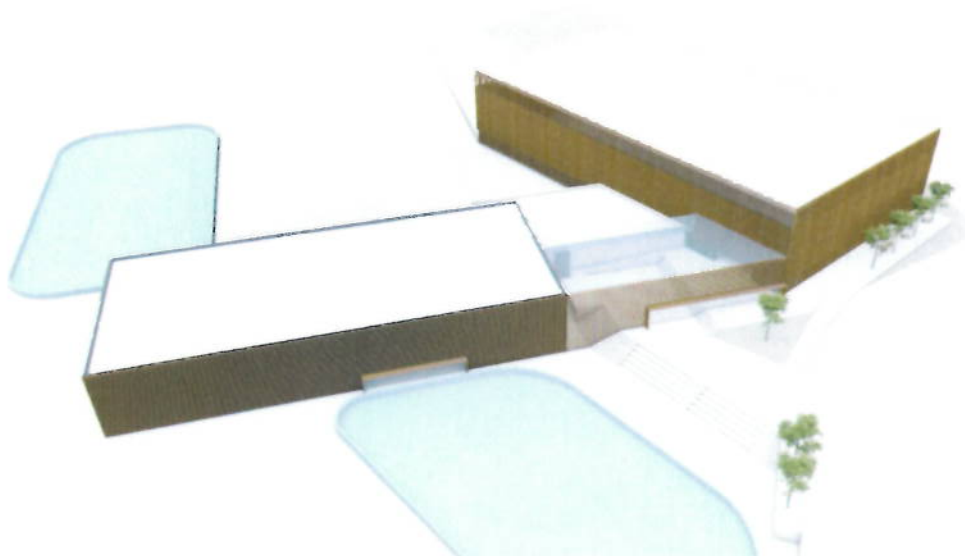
Konzept SPORTPARK EISRING SÜD : Luftbild : Darstellung der Baukörper mit möglichen Außeneisflächen
